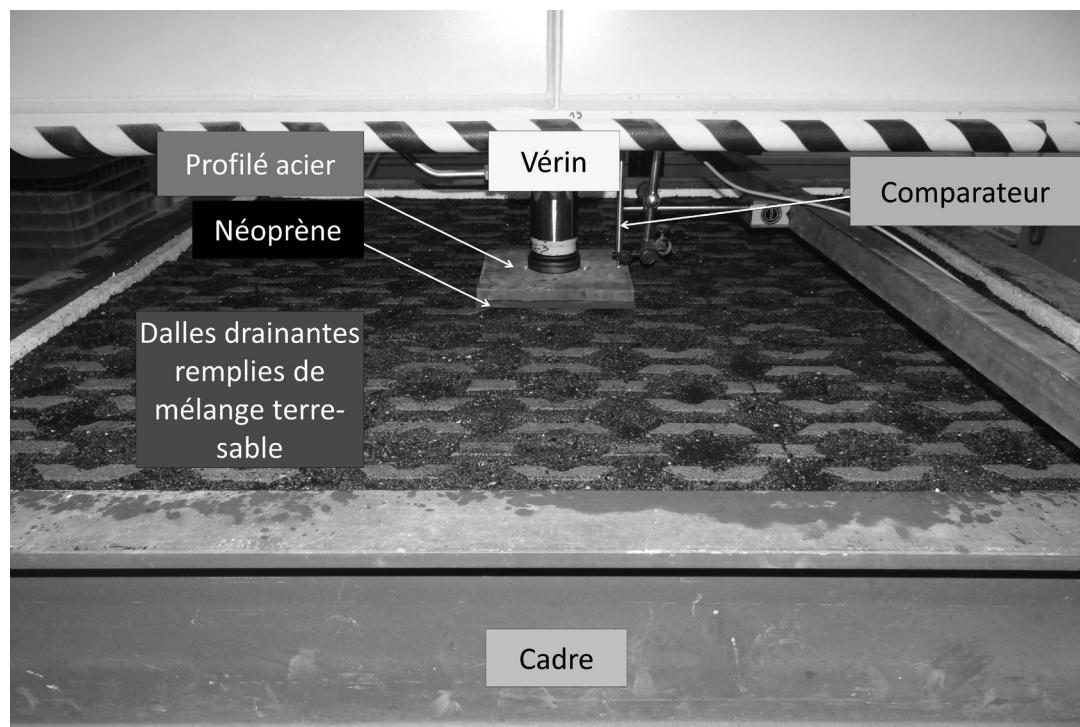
Schéma du dispositif d'essai en conditions de pose sur dalles drainantes
